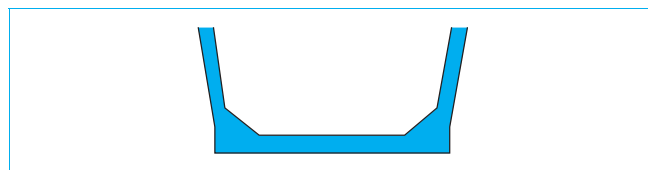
Géométrie du bas de caisson d'un pont poussé à âmes inclinées
